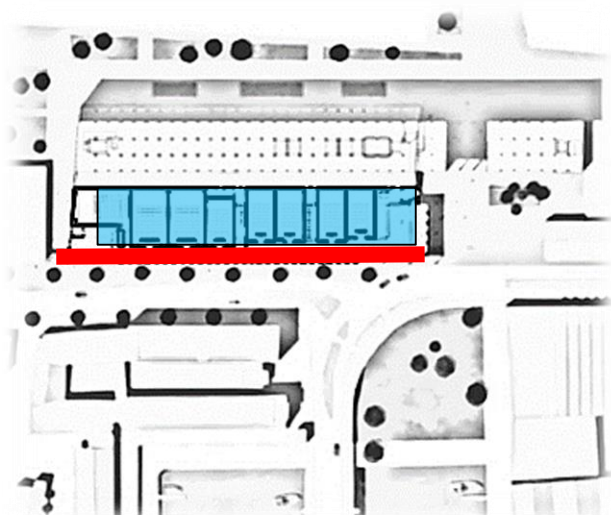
Plan d'étage Théâtre de Maastricht Pathé
